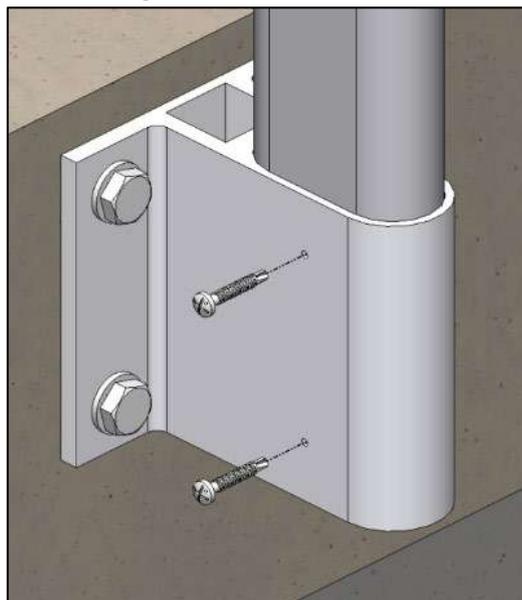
Fijación del montante sobre el pie montante a pared.
